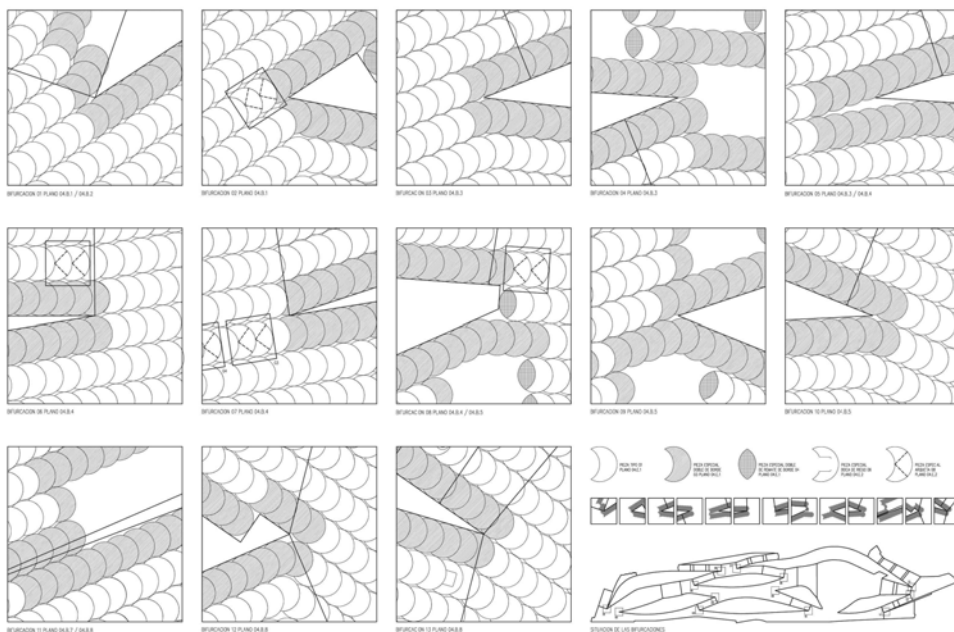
Disposición de Piezas de Pavimento por Rutinas LISP, Proyecto de Parque Litoral, 2003.
